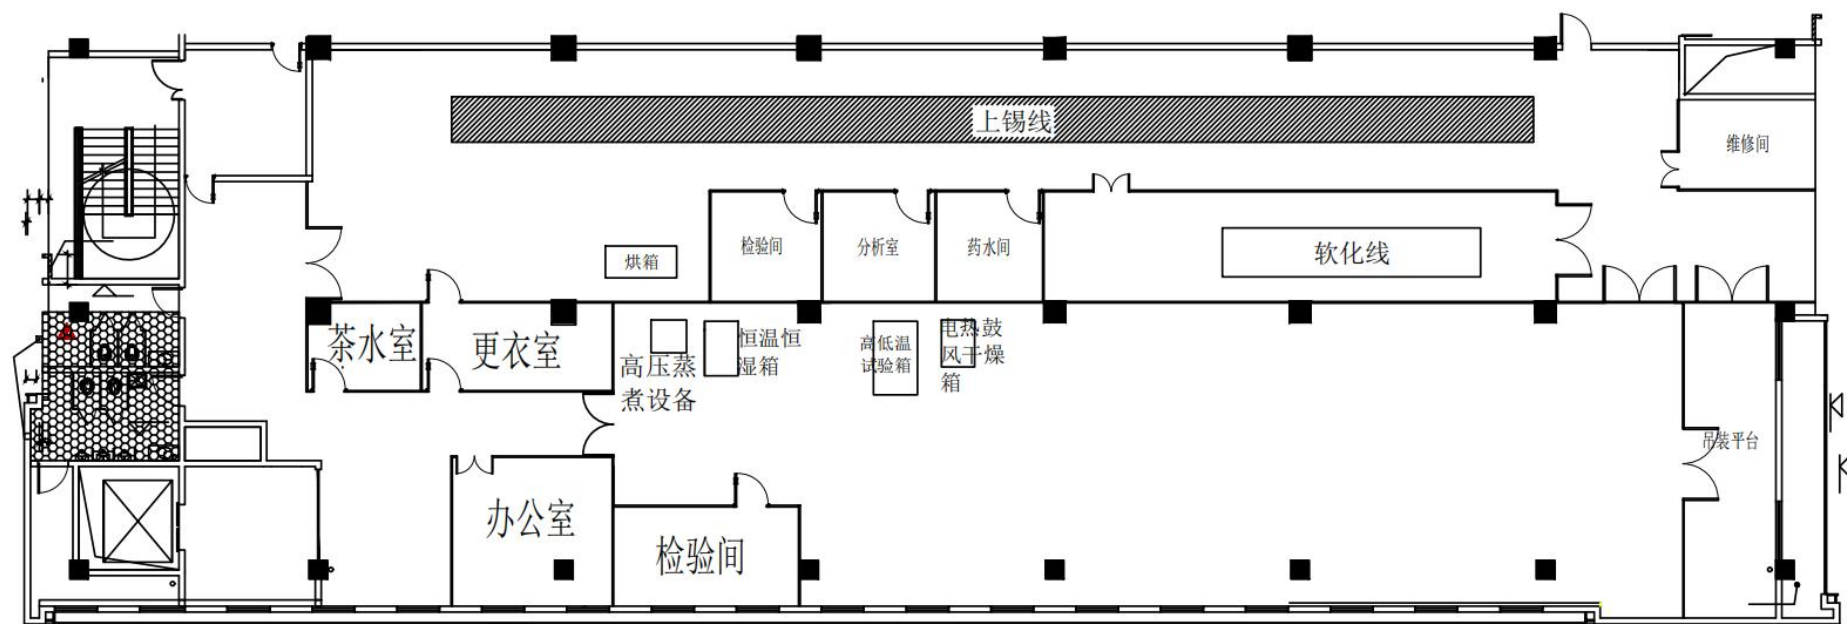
7#厂房二层平面布置图（原环评中为办公室，变更为生产车间）
